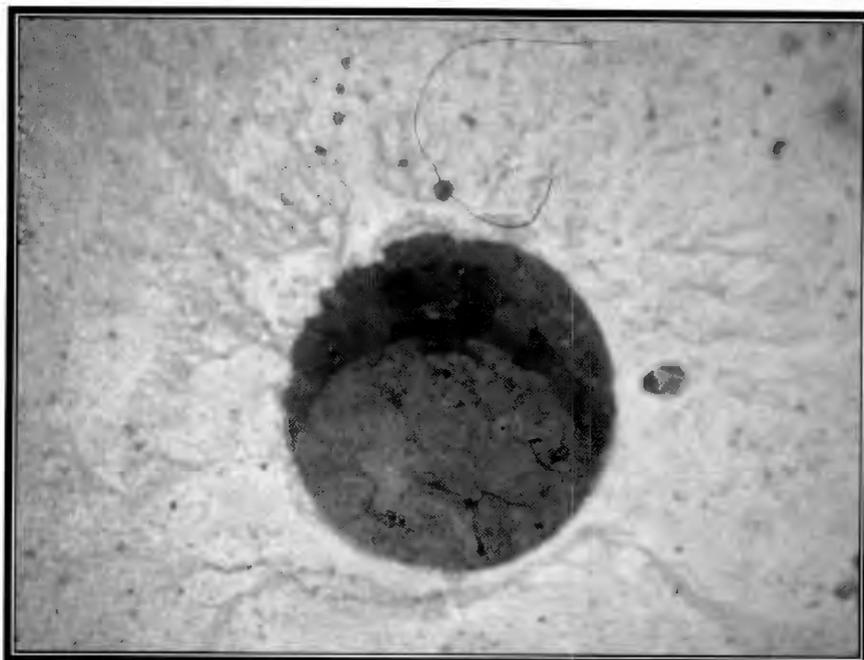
Vista superior de drenes verticales tapados con hormigón.
